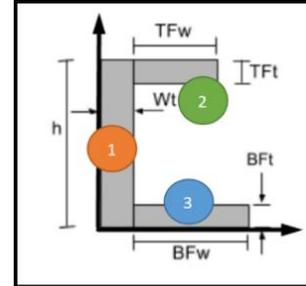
Perfil de las vigas de las torres de soporte. Fuente: Elaboración propia.
